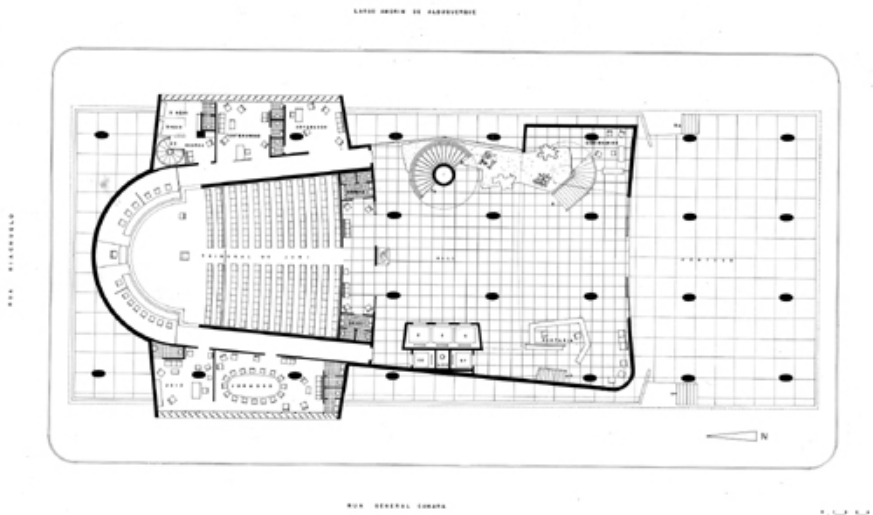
Planta do pavimento térreo. Projeto de 1952.
